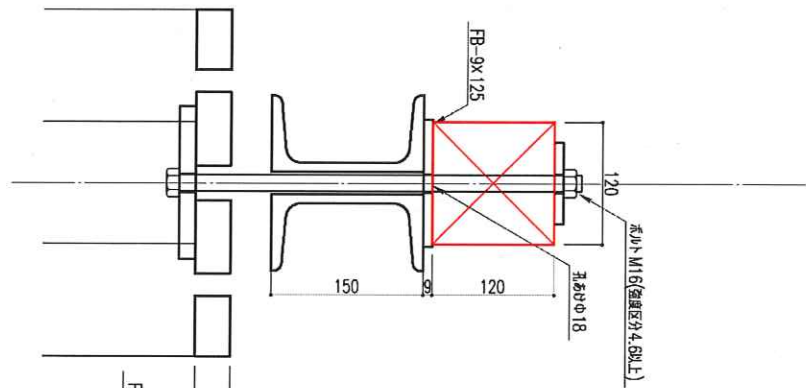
試験法 B 治具詳細図 (1) (単位: mm)
